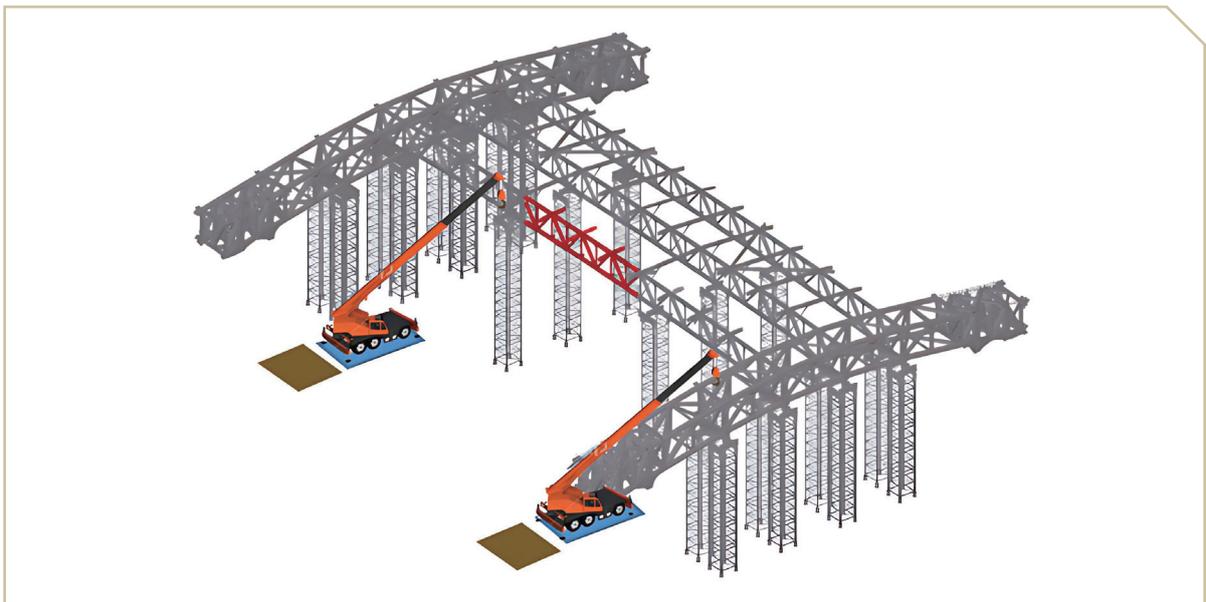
次桁架施工順序圖(4)－第 3 段桁架閉合及水平斜撐桁架 (Bridge Truss)
